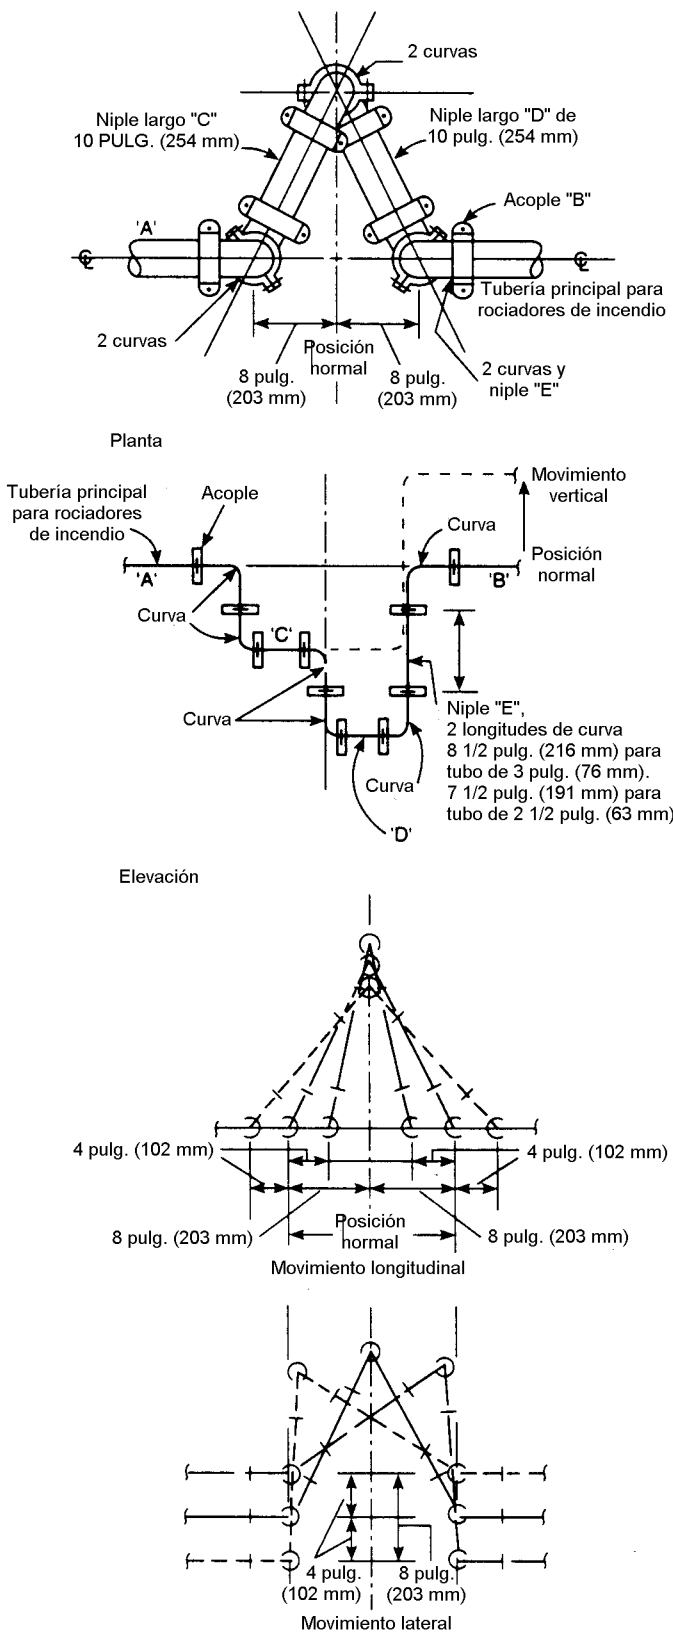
Conjuntos de Separación Sísmica. Ilustra una separación de 8 pulgadas (203 mm) cruzada por tuberías de hasta 4 pulgadas (102 mm) de diámetro nominal. Para otras distancias de separación y diámetros de tubo, debe modificarse proporcionalmente.
